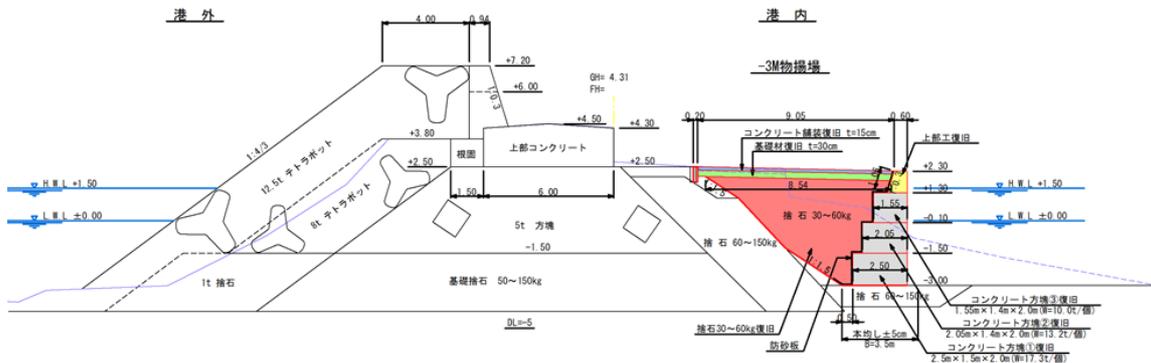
No.25 大洗港区_第1埠頭地区A物揚場 (-3m) の断面図 (復旧後)
